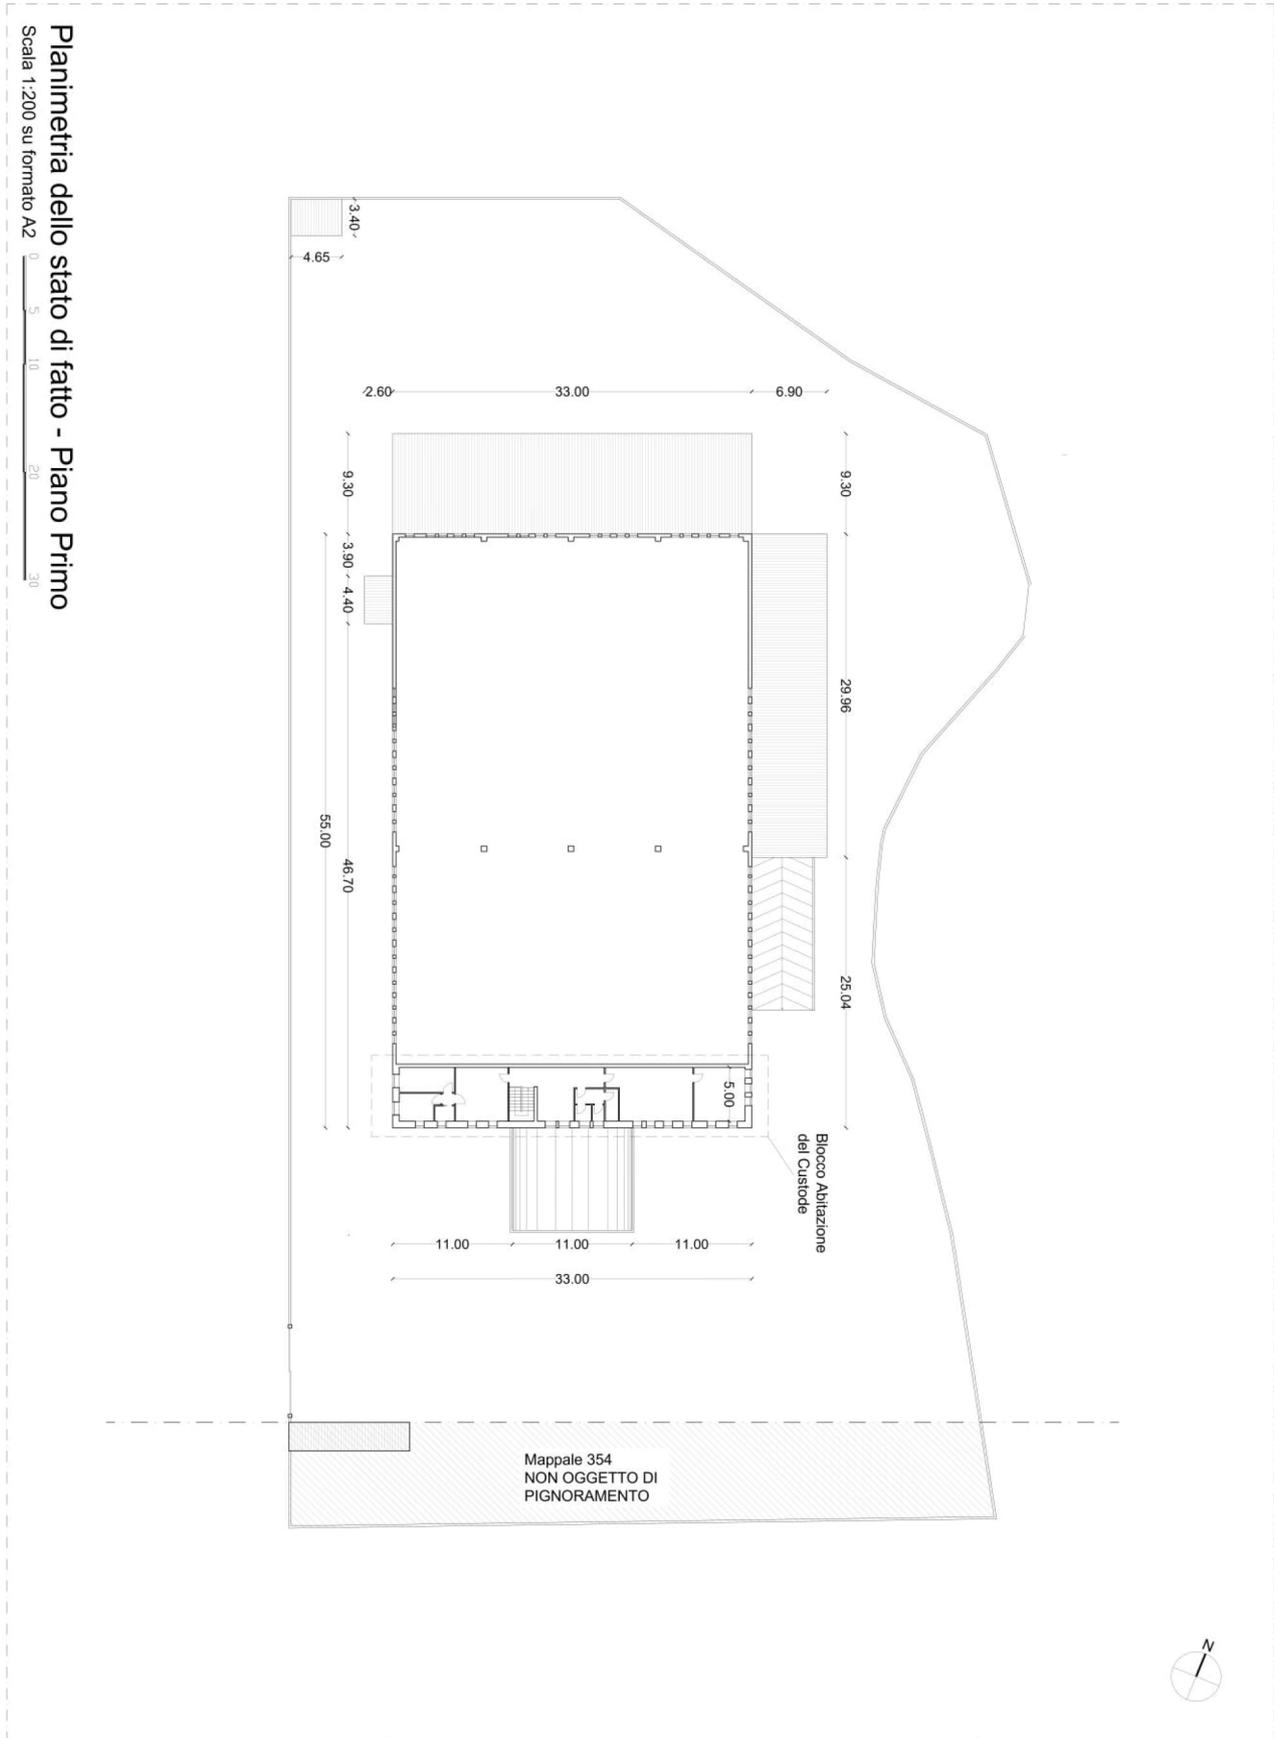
Planimetria dello stato di fatto – pianta piano primo
